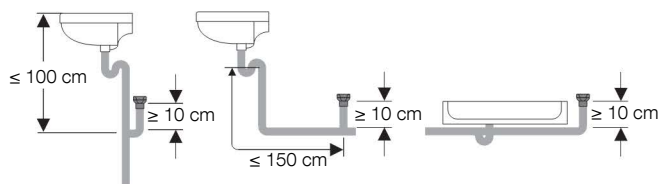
Einbaumasse Geberit Rohrbelüftungsventil GRB50
